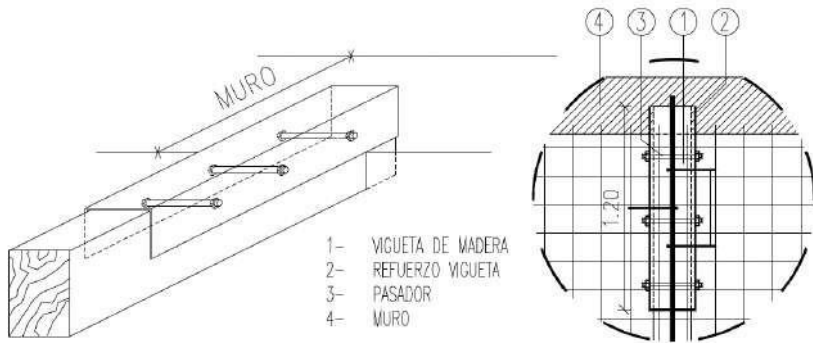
Detalle de refuerzo de la cabeza de vigueta en muro de la vivienda. Fuente propia
